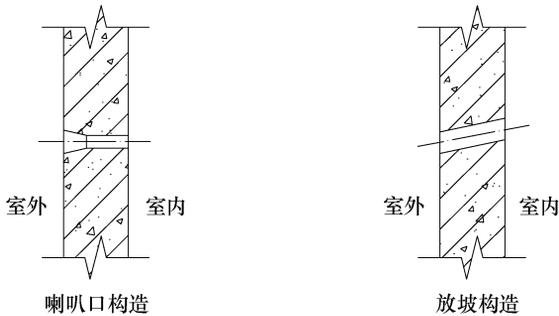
预制混凝土外墙模板对拉孔构造示意图
